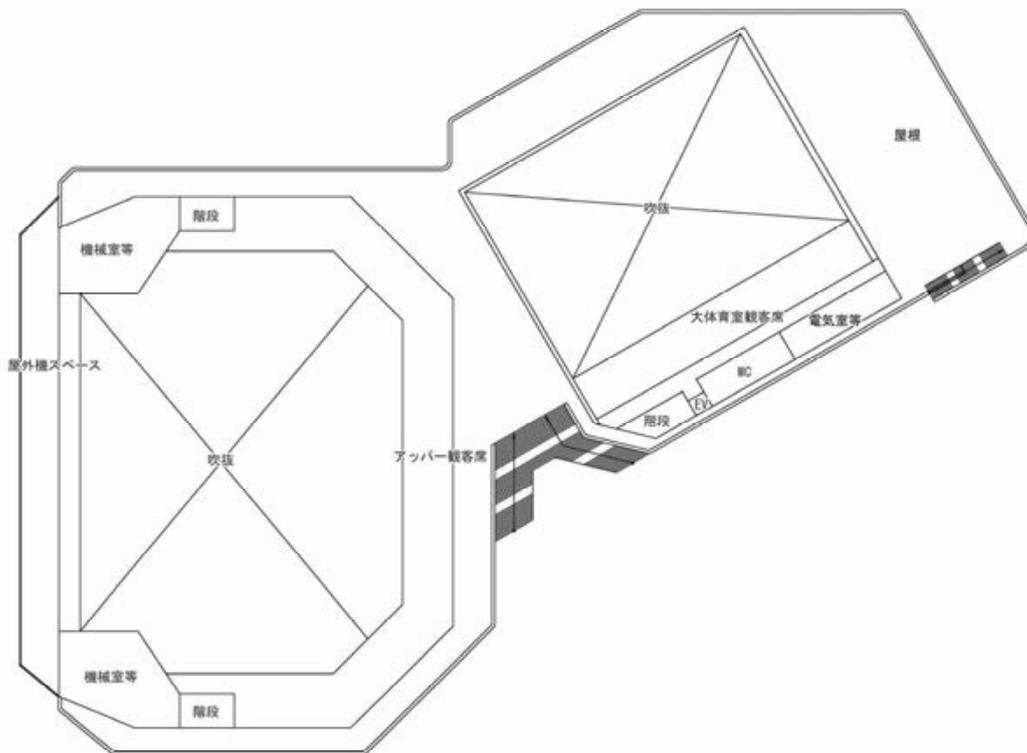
(8) (新) とどろきアリーナ・スポーツセンター平面図 (B1F,1F 平面図)
